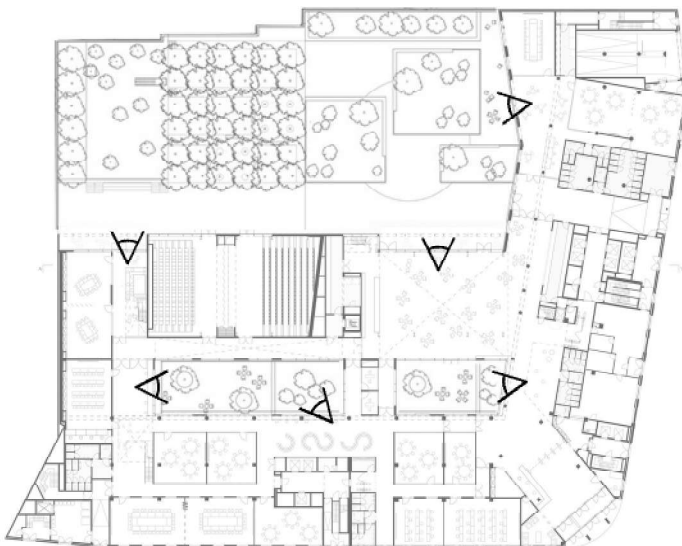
Diagrama de vistas sobre plano de la planta baja.
